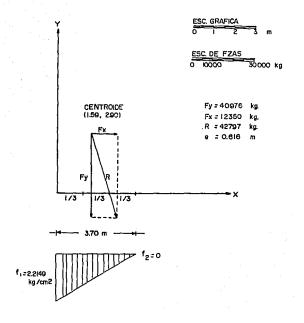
ESFUERZOS EN LA CIMENTACION DEL CANAL DESARENADOR.
